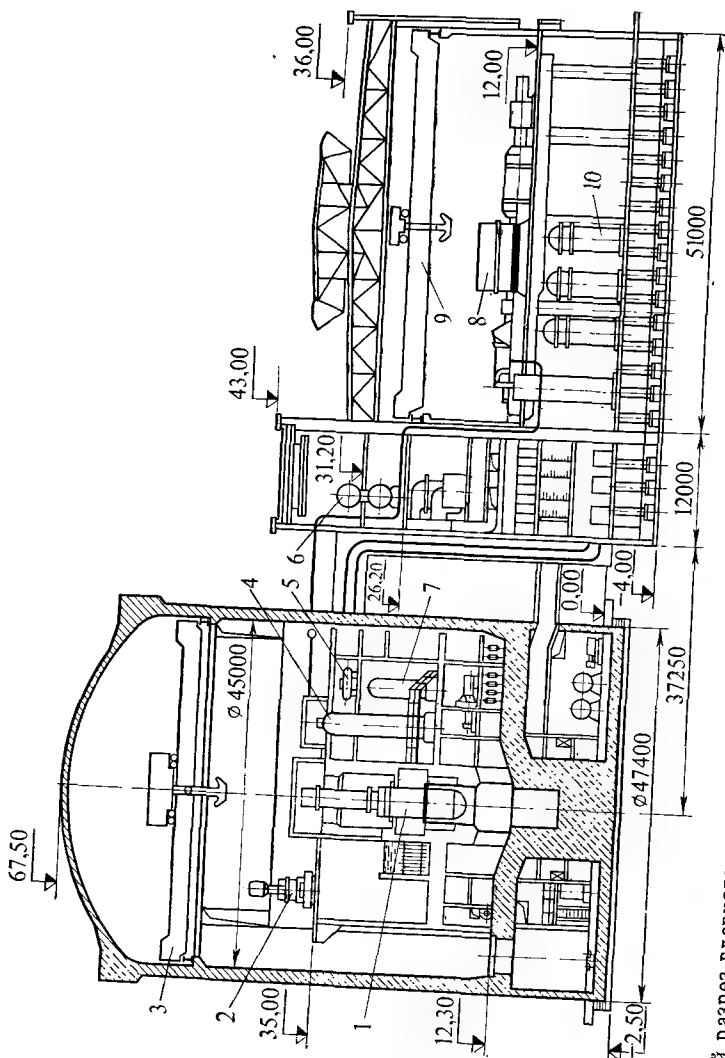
Поперечный разрез главного корпуса с реактором ВВЭР-1000:
